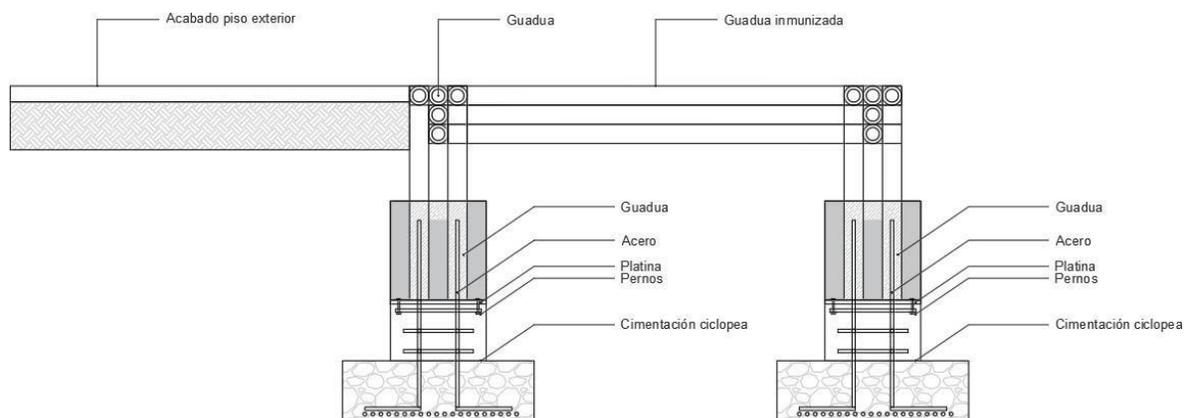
Detalle de entrepiso para propuesta arquitectónica, local en guadua
